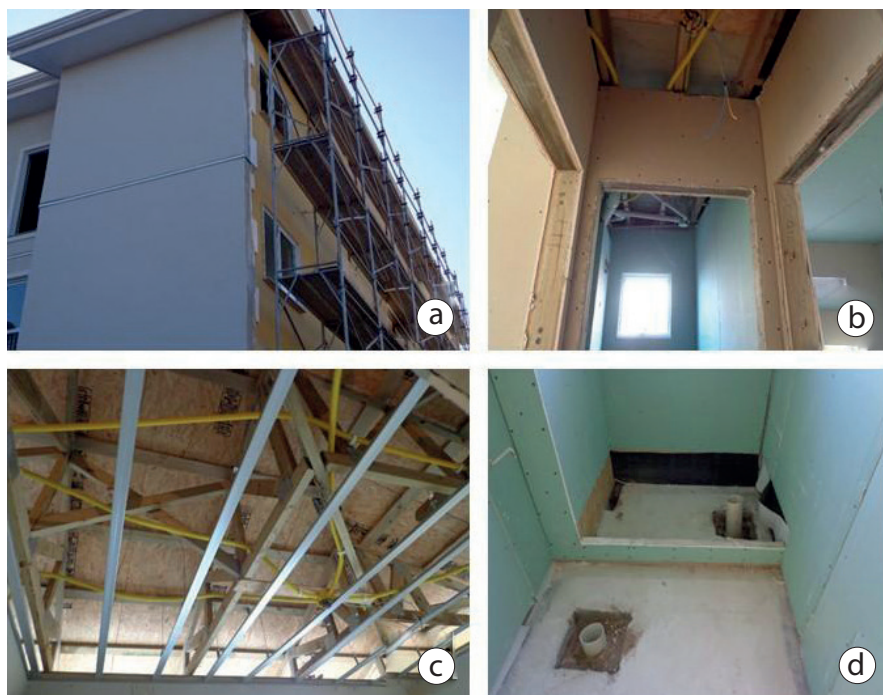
Edifício habitacional em execução em painéis estruturados em peças leves de madeira maciça serrada (a) Acabamento da fachada; (b) Vão das portas e chapeamento interno; (c) Estrutura da cobertura, forro e instalações; (d) Tratamento das áreas molhadas. Fonte: Autores (2016).
